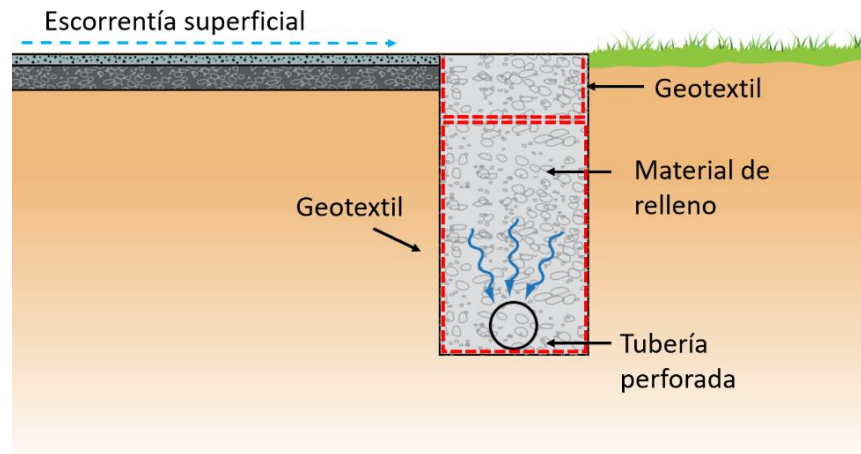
Esquema de un dren filtrante. Fuente: Adaptado de NHBC Foundation (2010).
